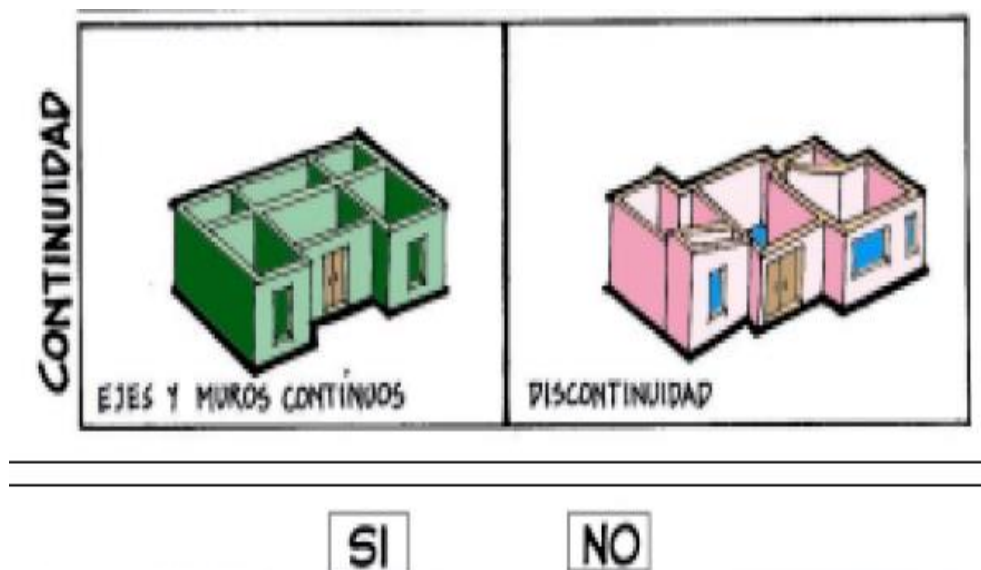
Forma correcta de diseñar en mampostería estructural mediante ejes y modulación.
